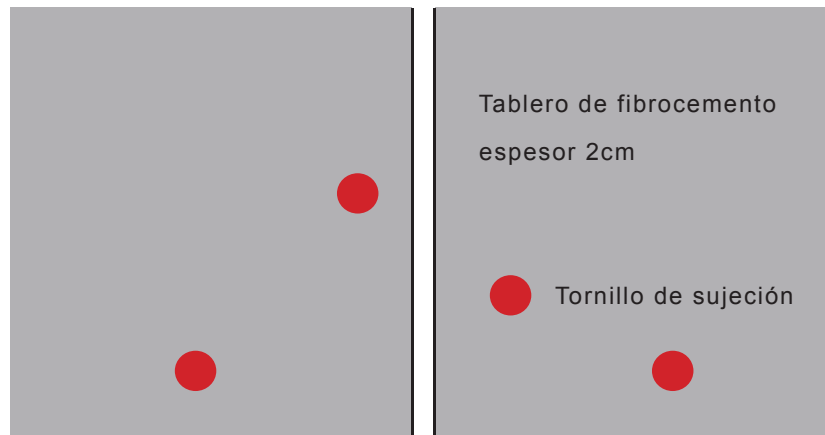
a Detalle de unión de dos placas de fibrocemento
